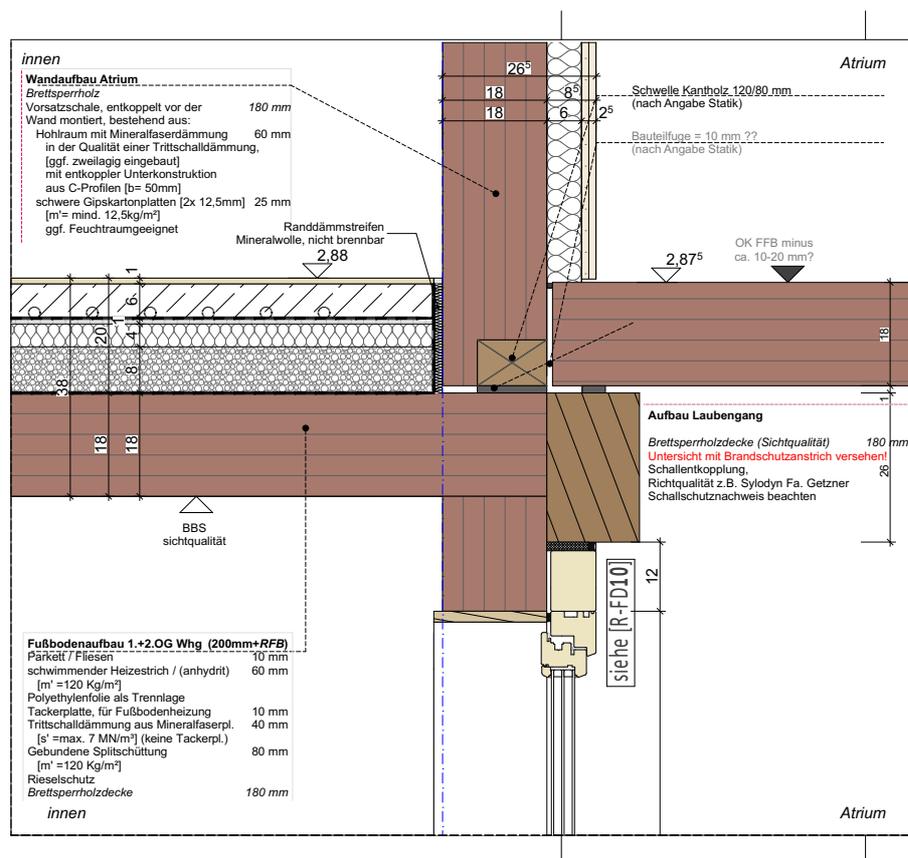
Plan 221-05-341-1 Atriumwand Laubengang 1. OG mit Fenster
